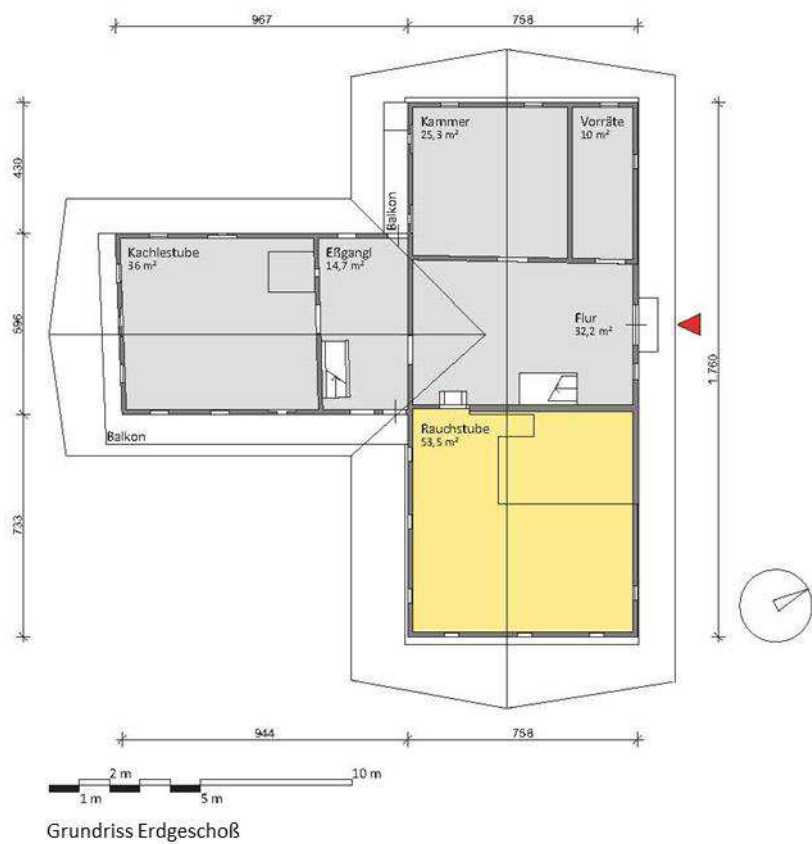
Grundrissdarstellung des Wohngeschoßes
